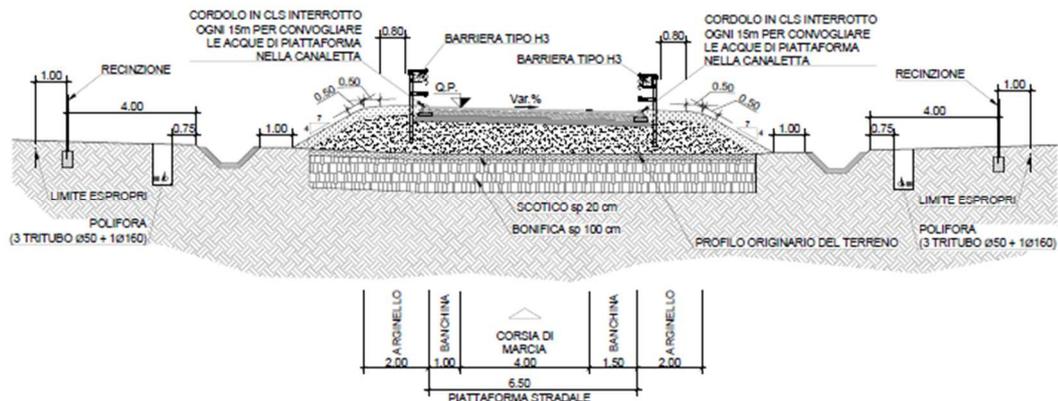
Sezione tipo rami di svincolo in rilevato rampa modirezionale
